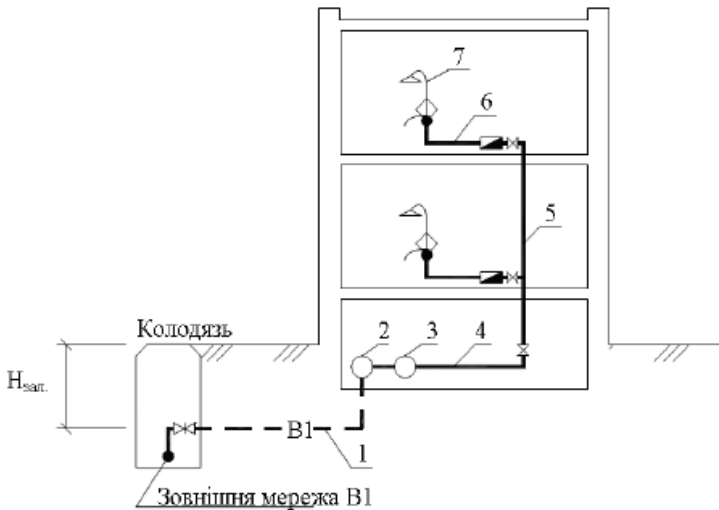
Елементи господарсько-питного водопроводу B1: 1 – ввід водопроводу; 2 – водомірний вузол; 3 – насосна установка (не завжди); 4 – розводяча мережа водопроводу; 5 – водопровідний стояк; 6 – поповерхове підведення; 7 – водорозбірна і змішувальна арматура
